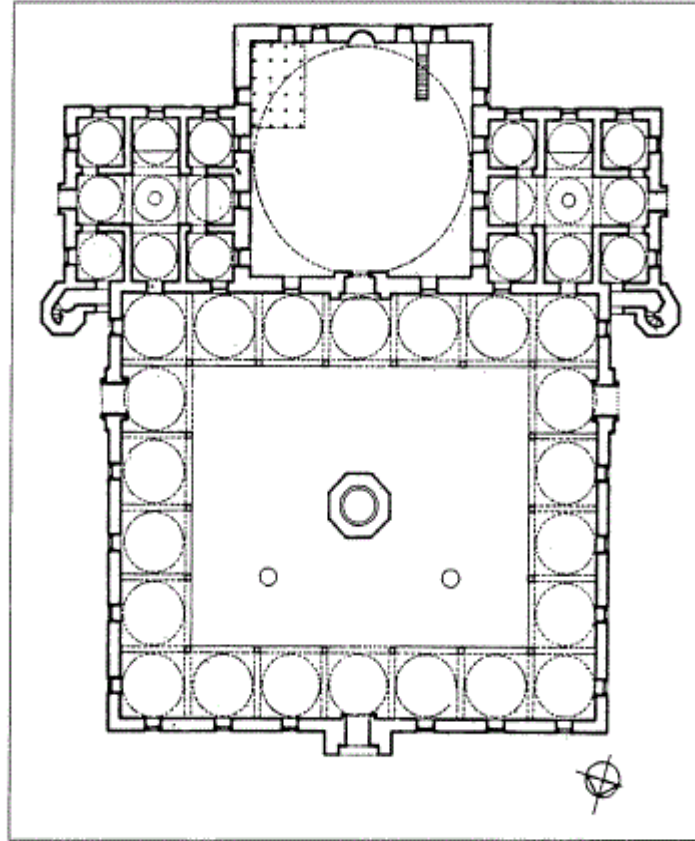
مسقط أفقي وقطاع لمسجد مراد الثاني في اسكوب (عن: ايفردى)
